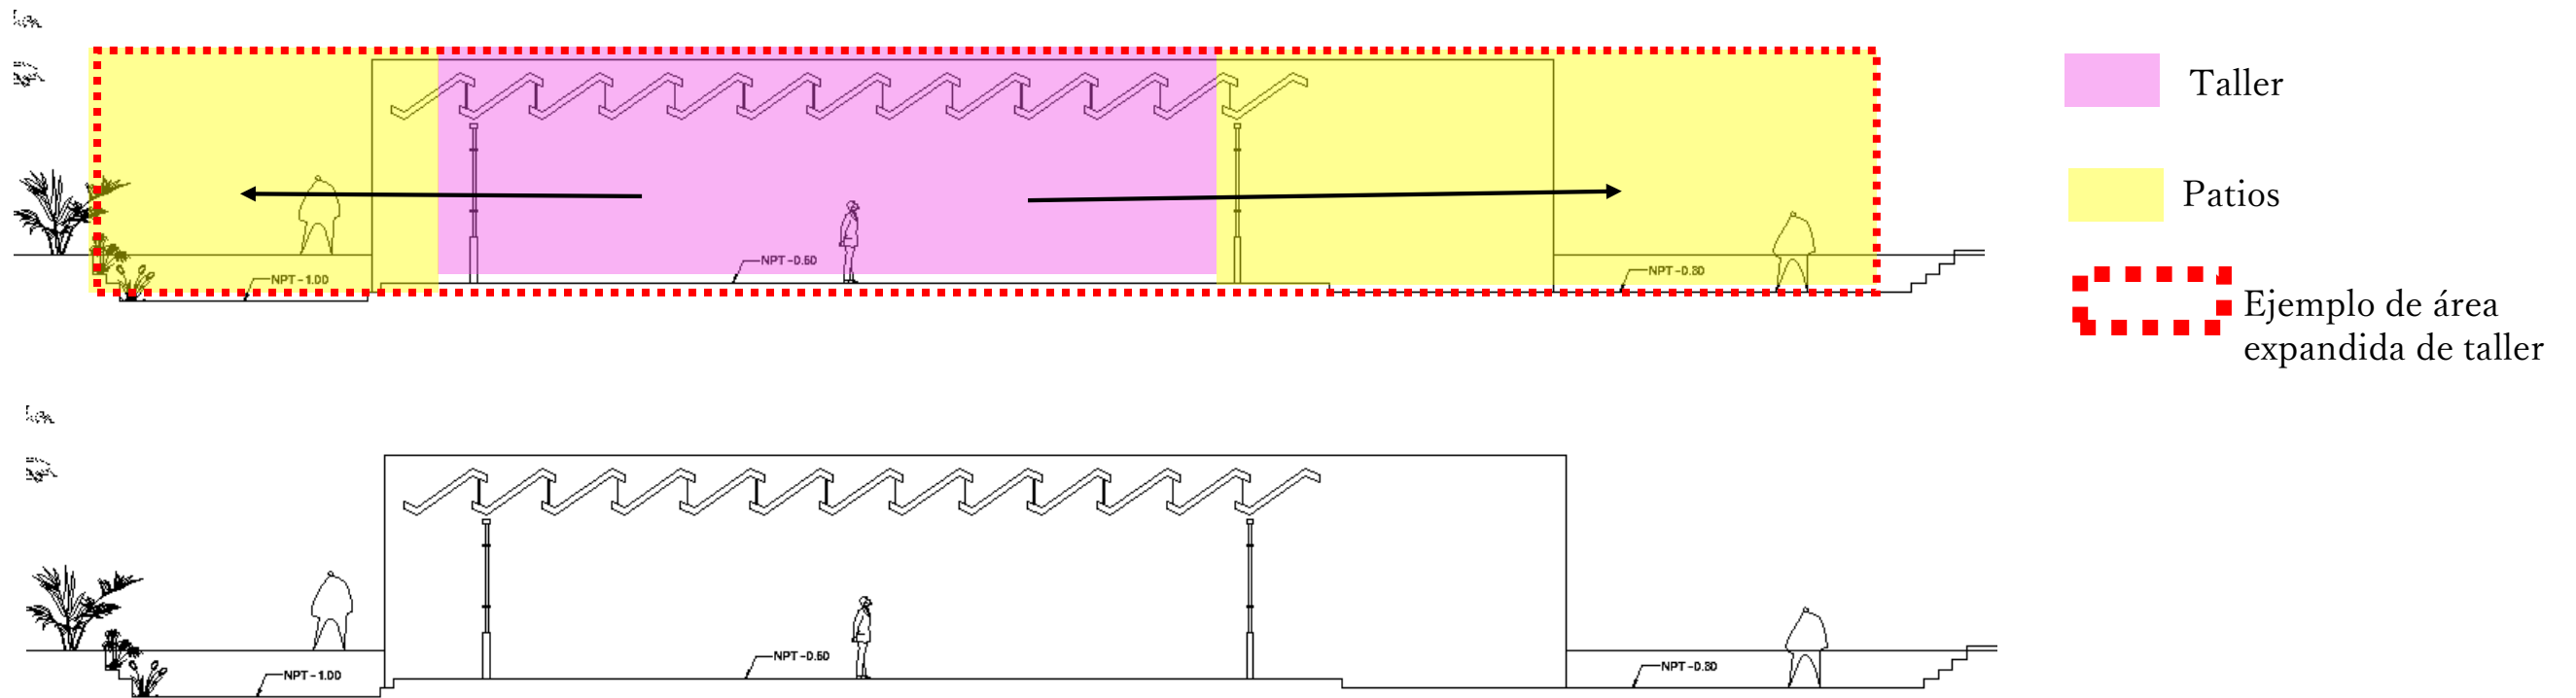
Planta de la zona de talleres Polo Cultural Bacardí
